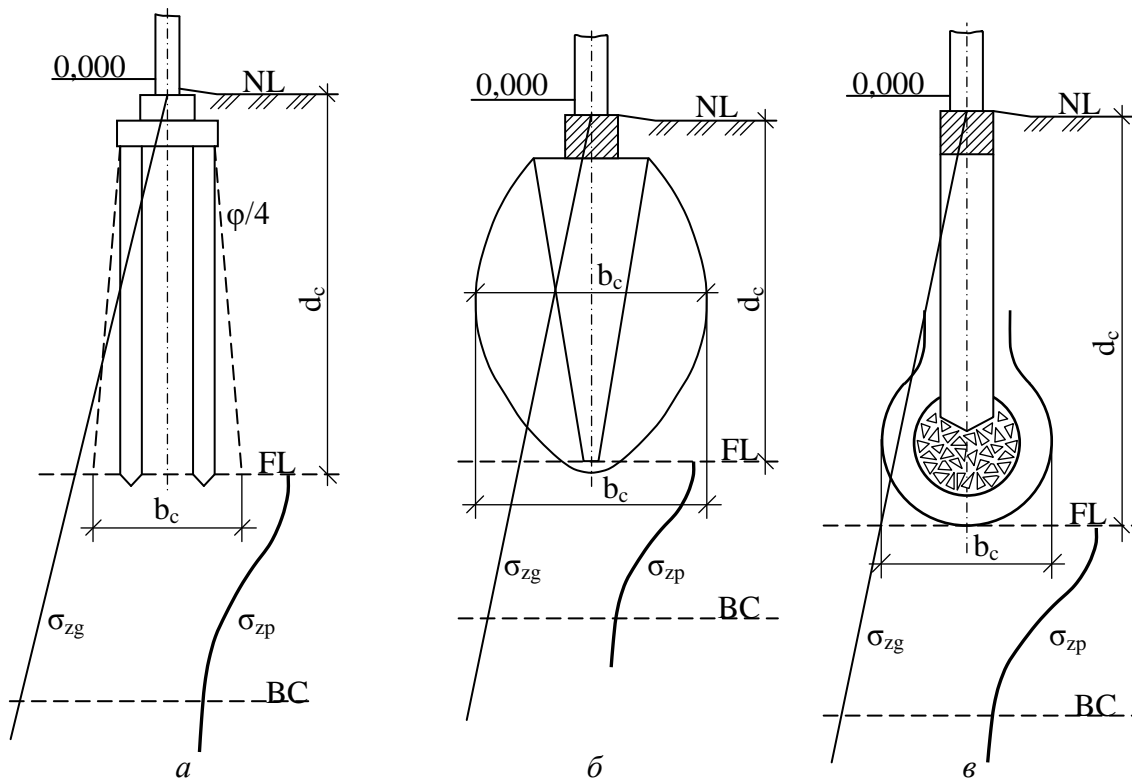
Схеми для розрахунку осідання фундаментів:
